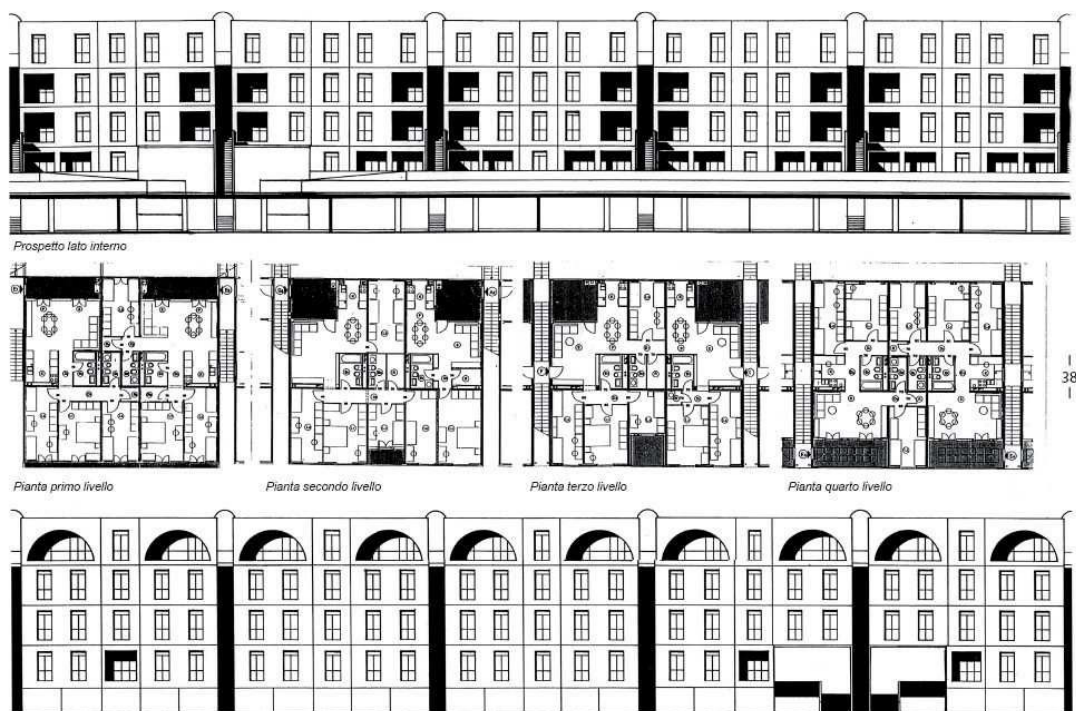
Pianta tipo e prospetti dell'edilizia bassa di Taverna del Ferro
